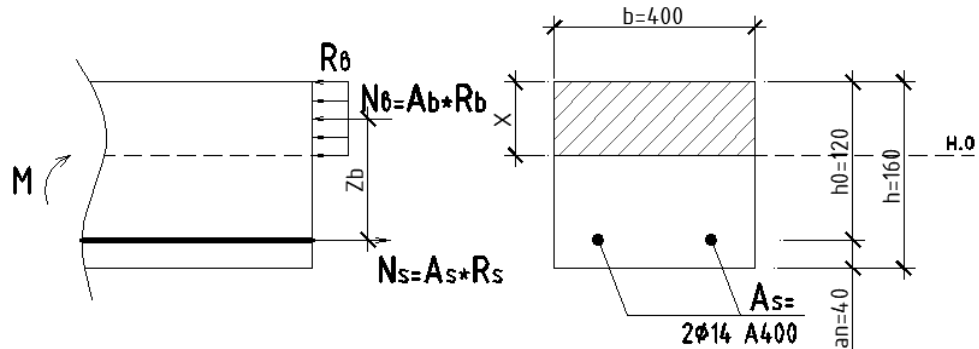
Схема внутренних усилий главной балки Г.б-1 в середине пролета
